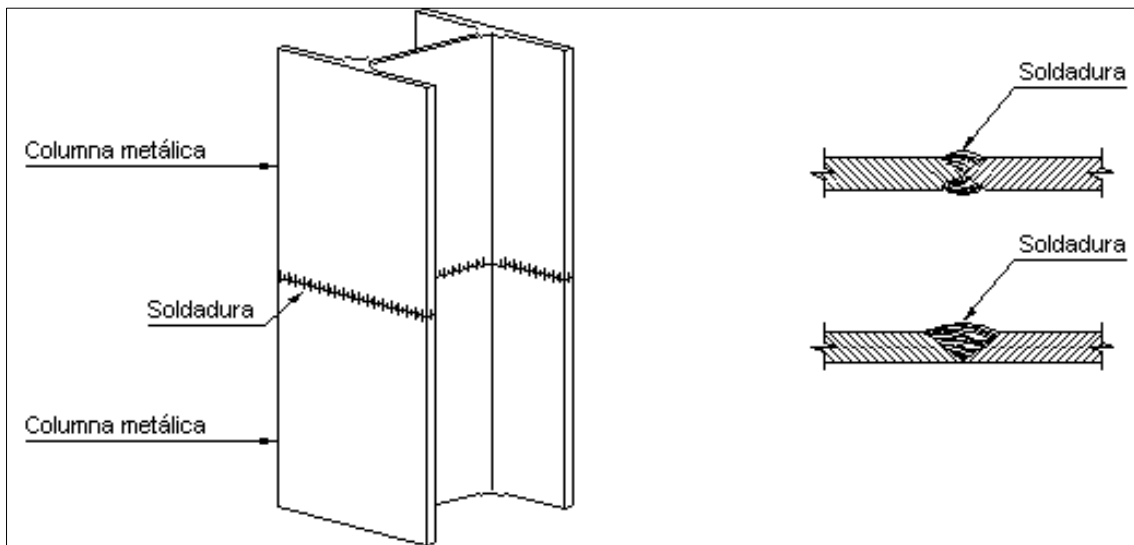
Columnas Metálicas. Fuente: <http://detallesconstructivos.mx.cype.com/CYA69BB>
